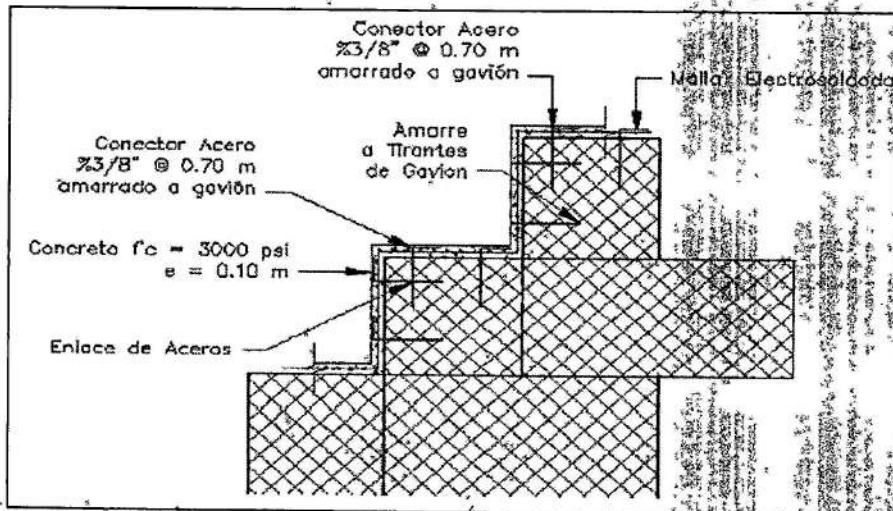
Detalle Refuerzo de Protección Externa de Gabión.
